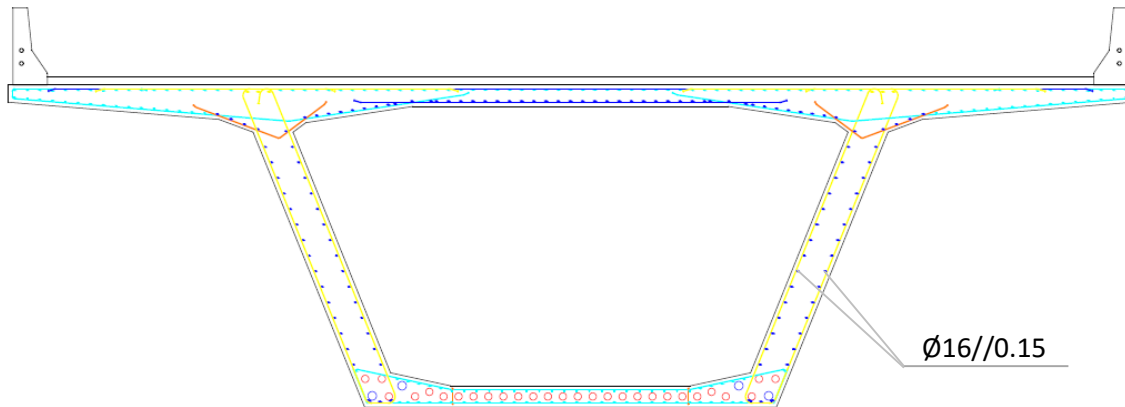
Exemplo da distribuição de armadura na secção transversal
